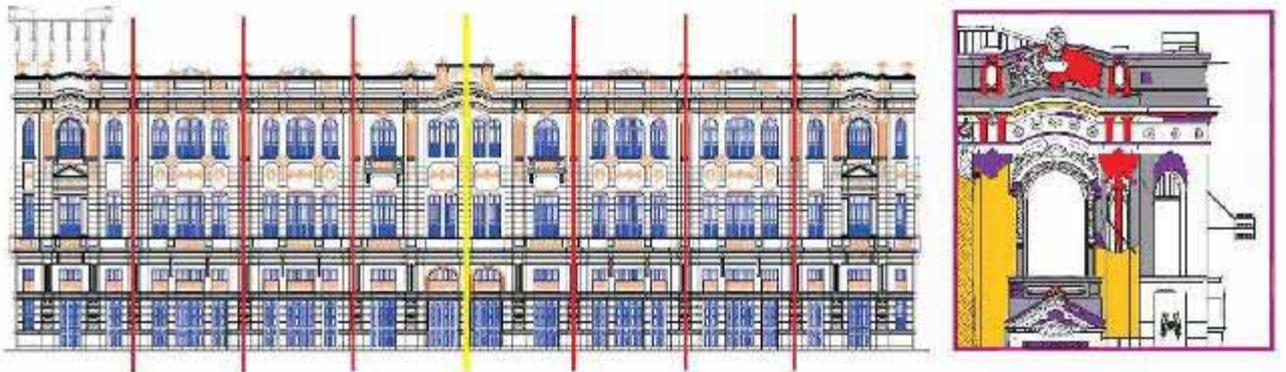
Levantamento da fachada norte do Chanteclair (Acervo pessoal Luciana Menezes, 2001).
